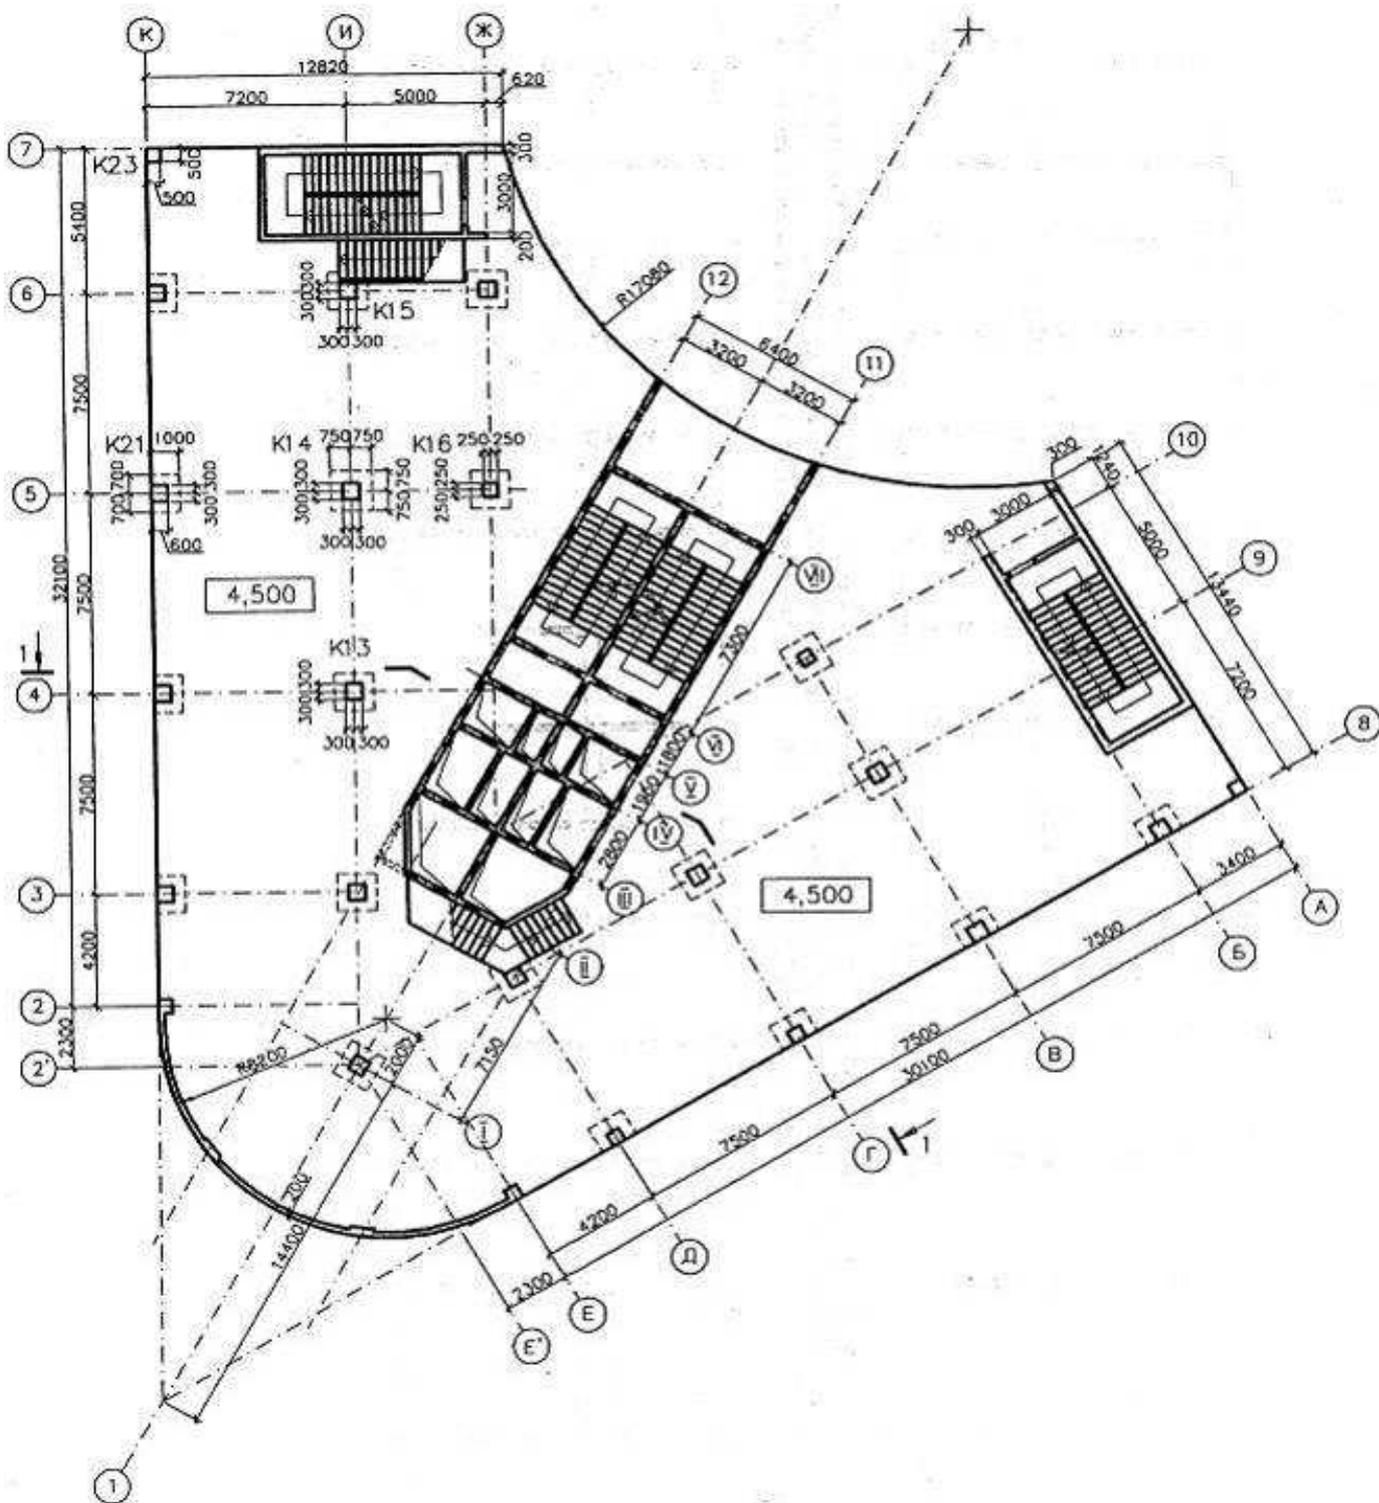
Схема плана второго этажа на отметке +4,50 м к расчету железобетонного каркаса 14-этажного каркасно-ядрового здания на предотвращение прогрессирующего обрушения
